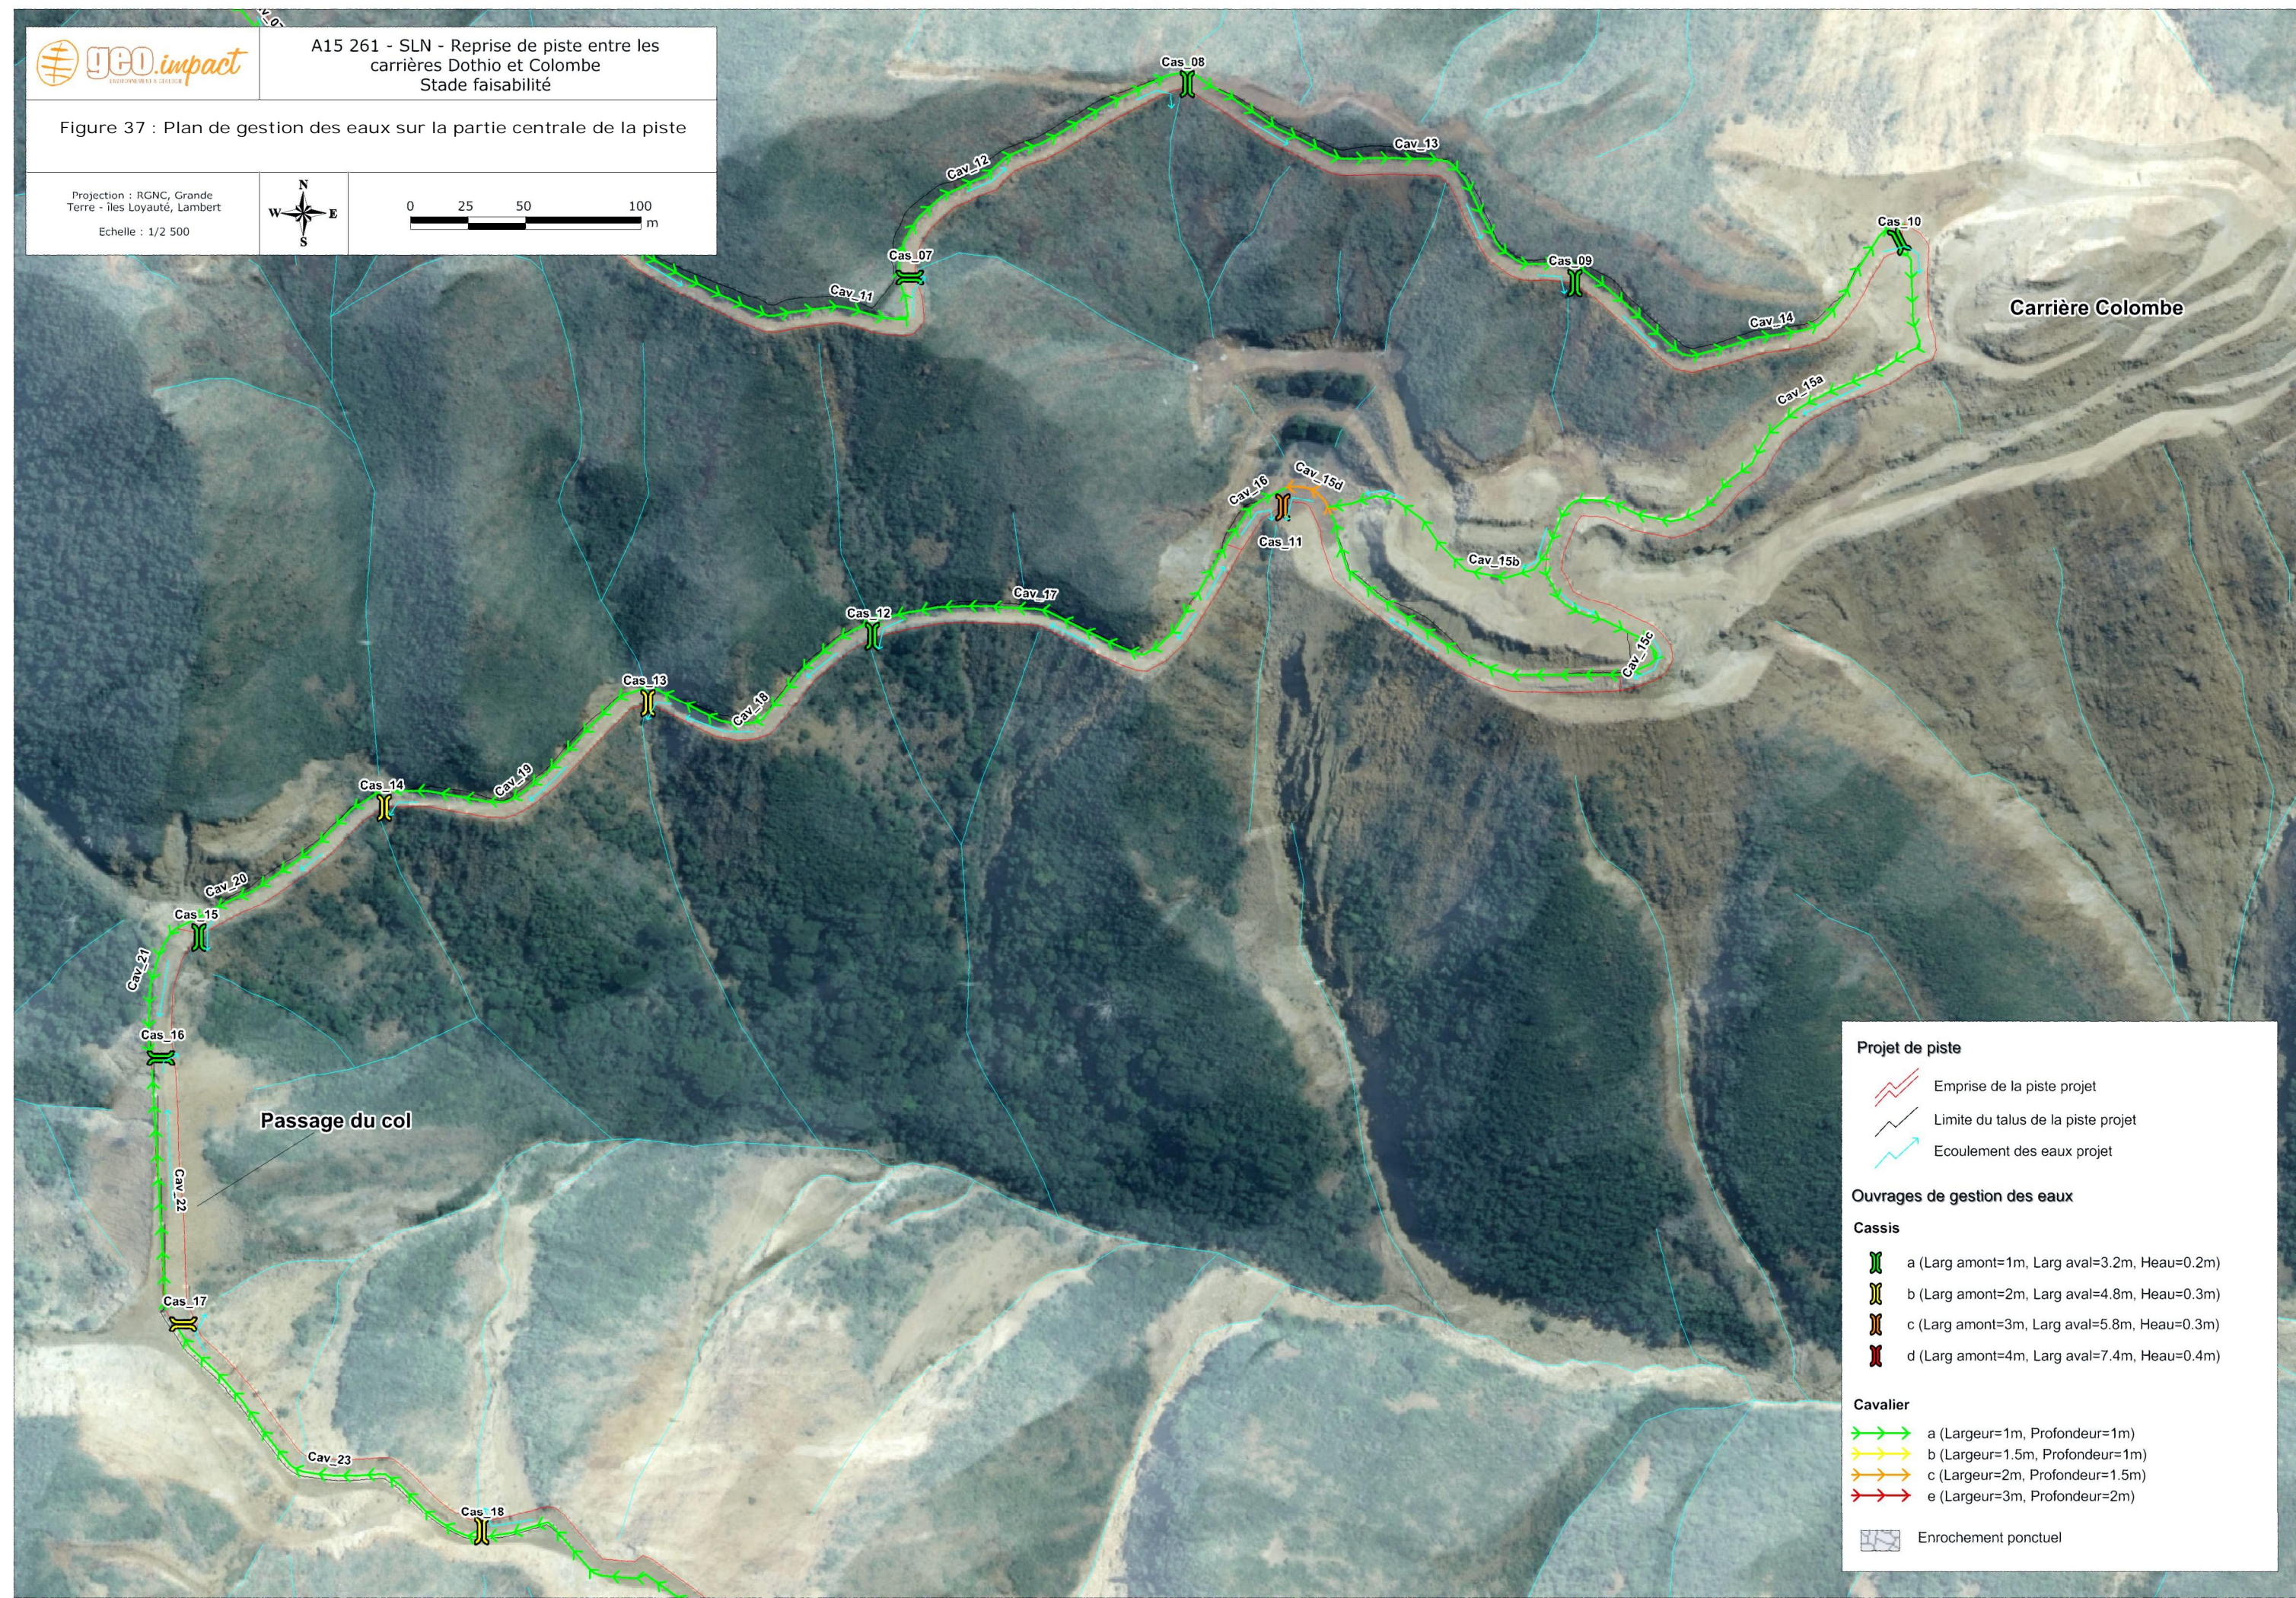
Plan de gestion des eaux sur la partie centrale de la piste
